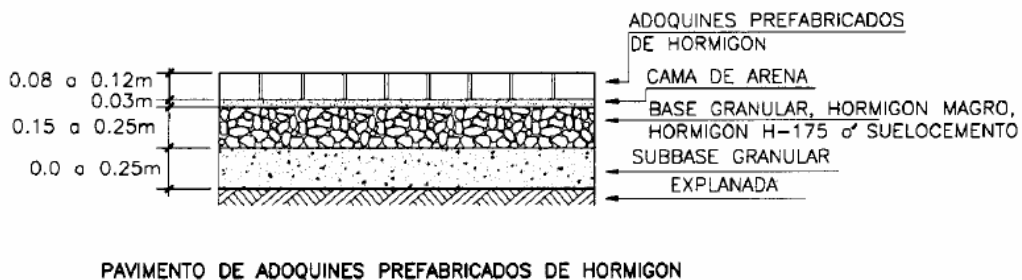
Sección tipo del pavimento de adoquines de hormigón
